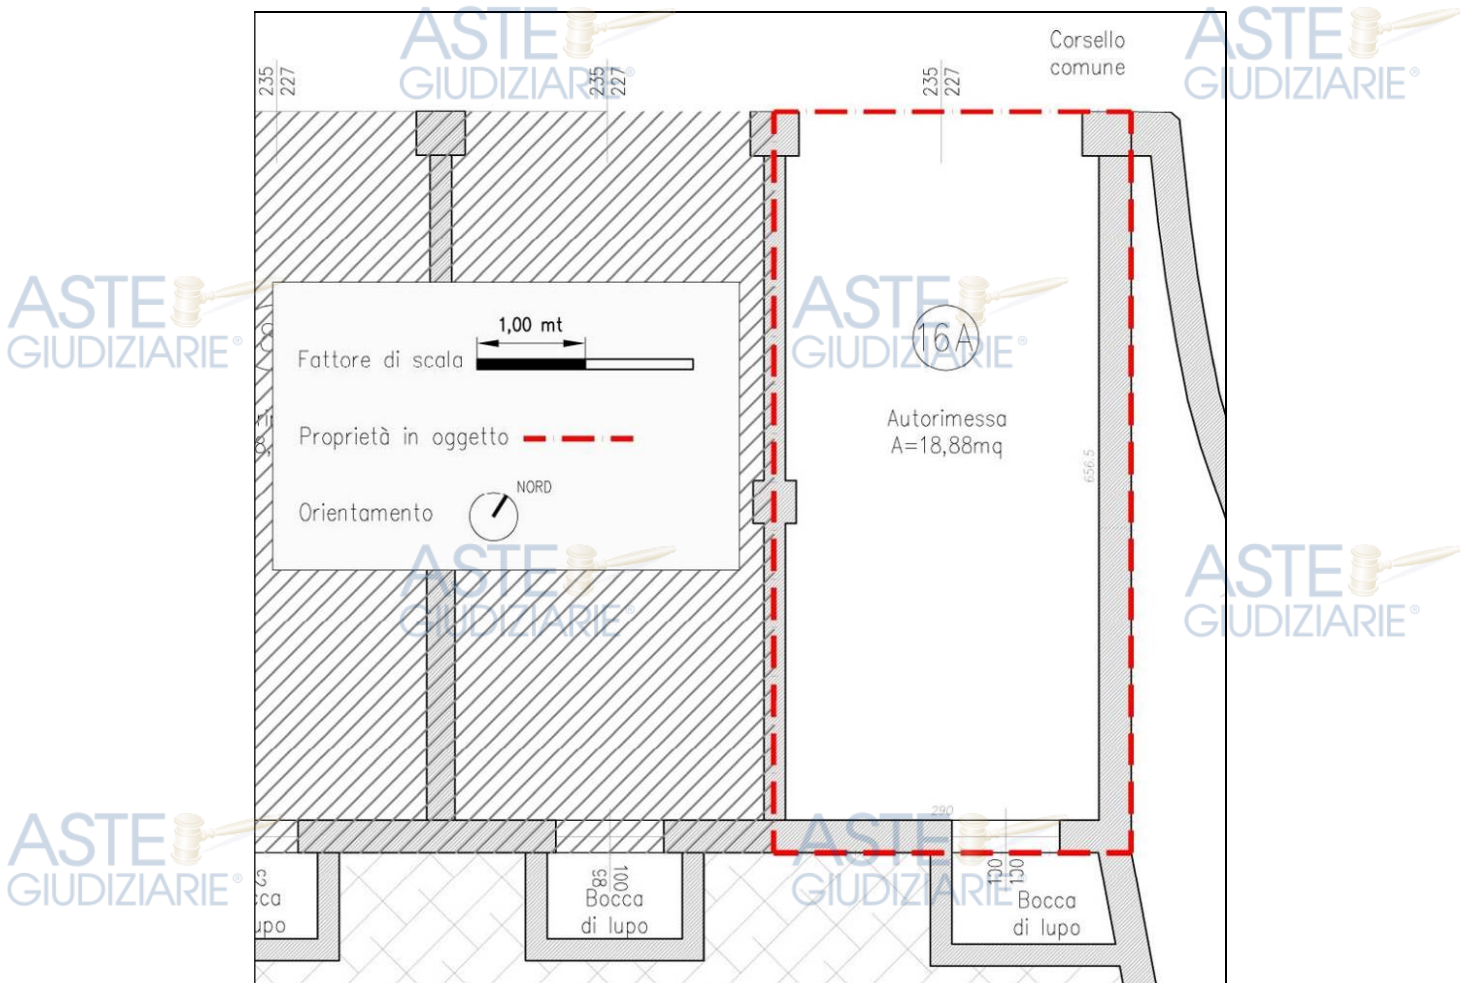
Piano interrato autorimesse – Pianta di rilievo autorimessa - Part. 336 sub. 32
